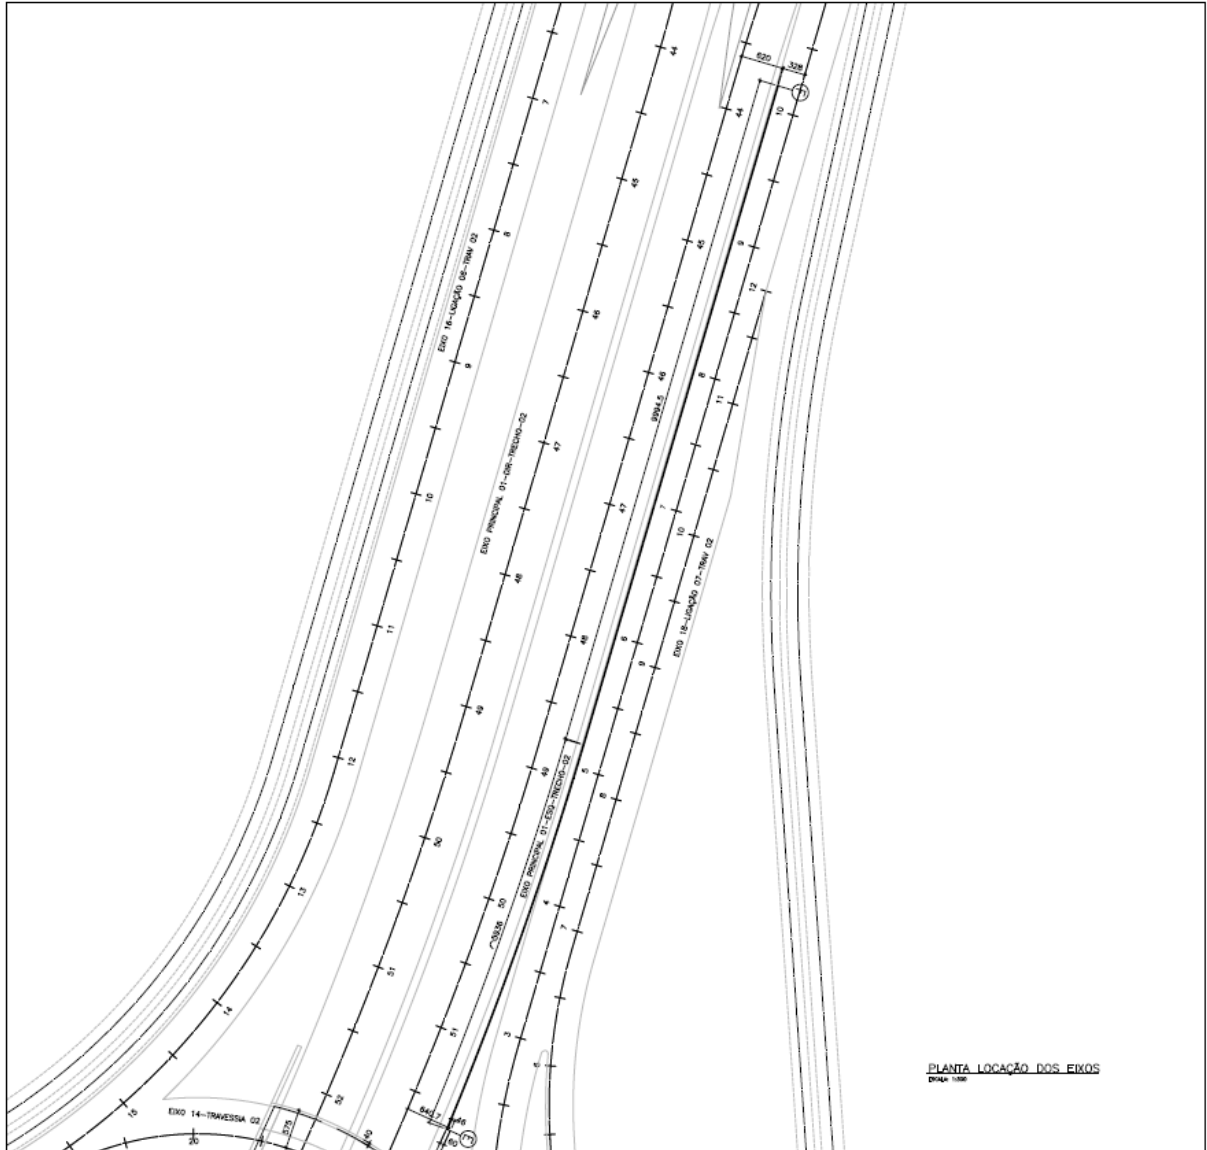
Planta – Localização do Solo Reforçado – Eixo EF
